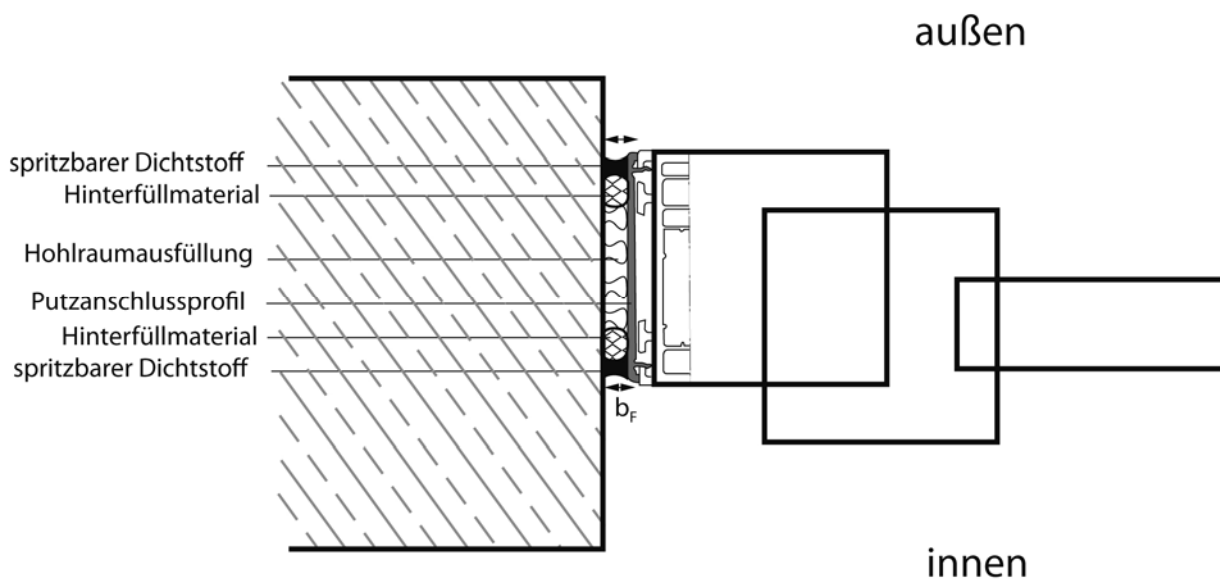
Einsatz eines Abdeckprofils ermöglicht eine fachgerechte Fugendimensionierung innen und außen
